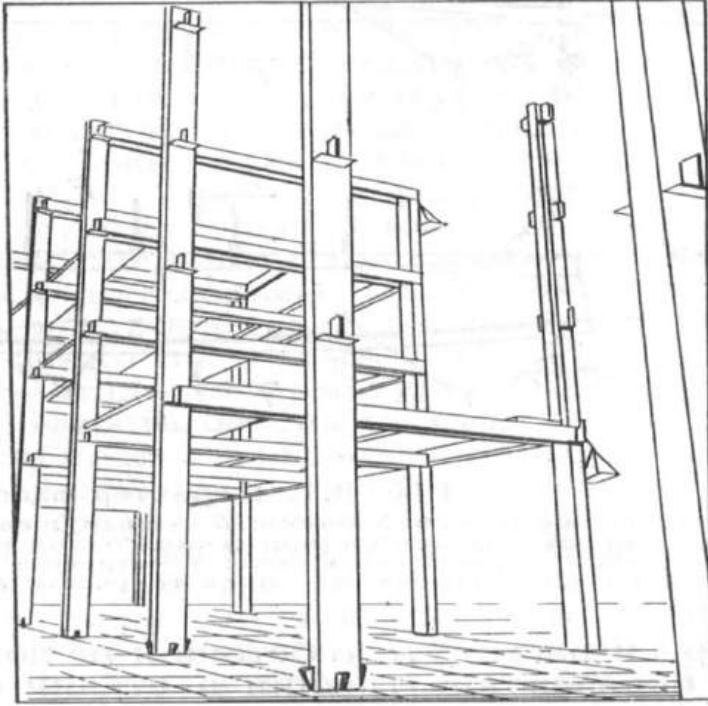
Залізобетонний каркас багатоповерхової промислової будівлі
